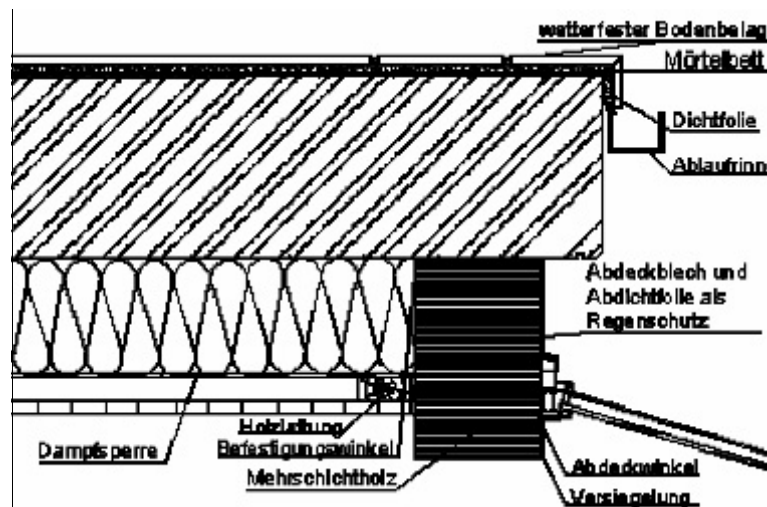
Dachanschluss an Balkonplatte, Bundesverband Wintergarten, Entwurf 2006
